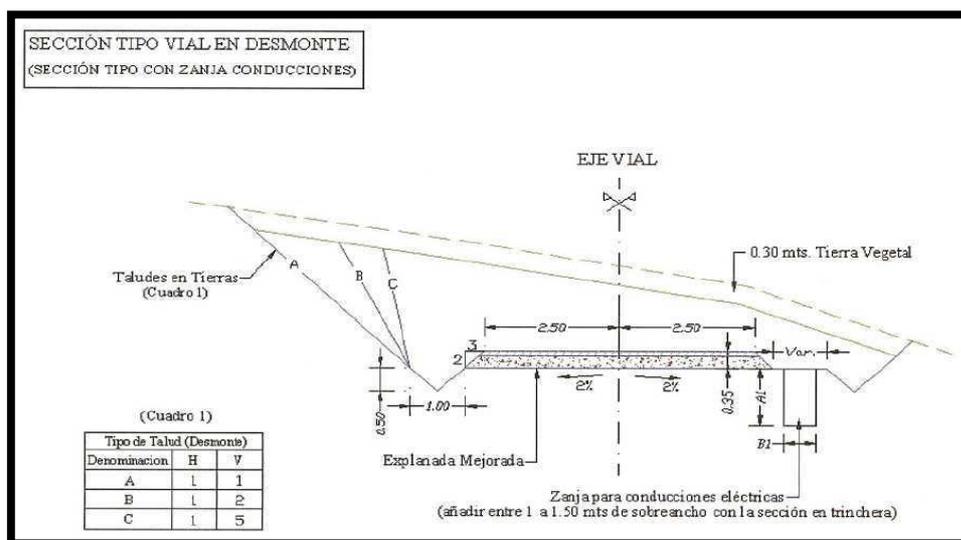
Detalle de zanjas para conducciones eléctricas paralelas a caminos internos.
